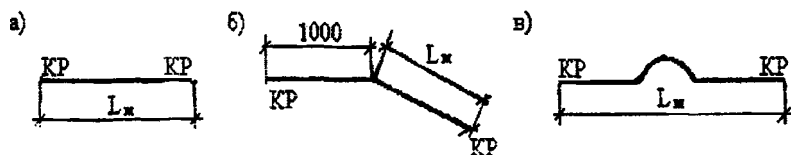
Типовые детали: а) – прямой опуск стояка; б) – чердачный опуск; в) – длинная скоба для подающего стояка
